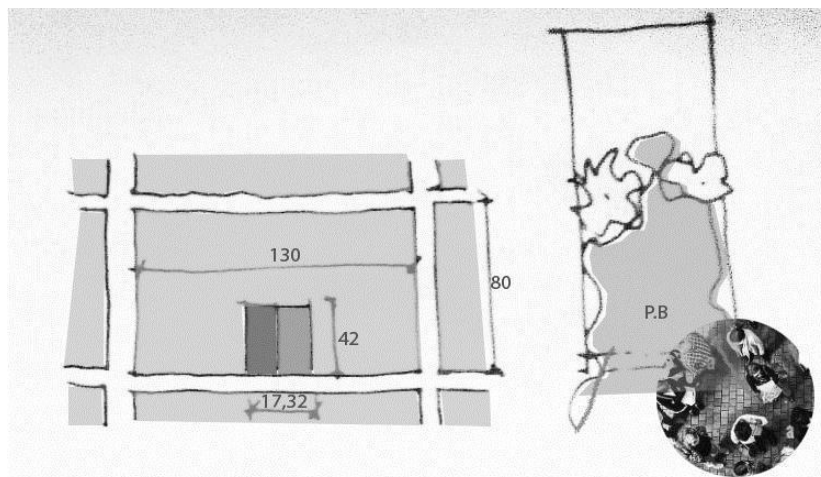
Lotes integrados en la manzana y planta baja como espacio de uso comunitario.
